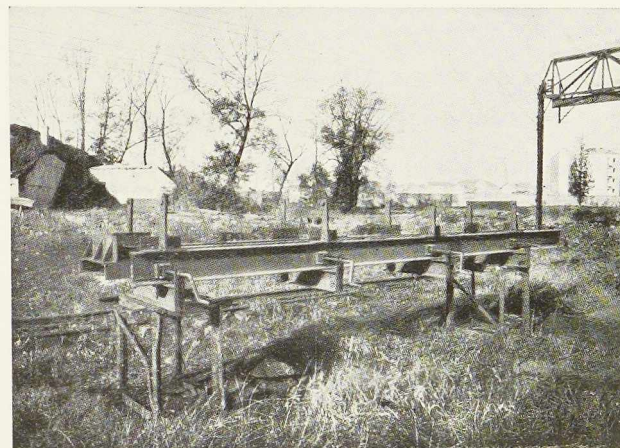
Assemblage des poteaux métalliques par soudure.
